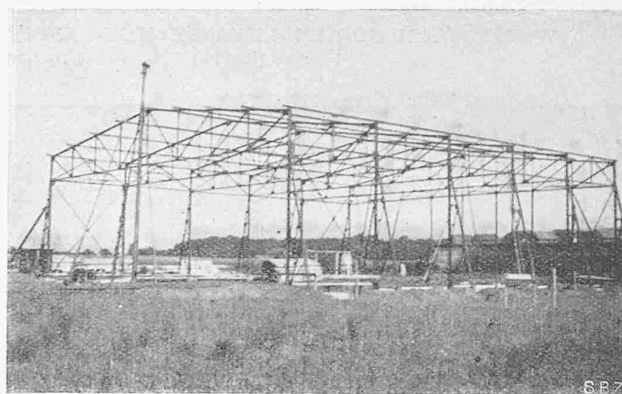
Fertig montierte Eisenkonstruktion der Halle.
